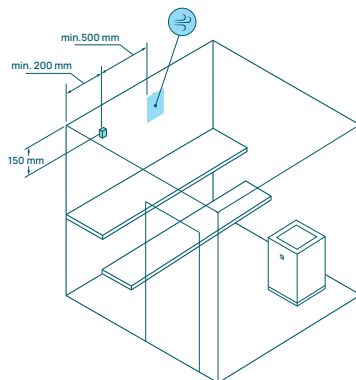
Posizione del sensore panca dall'angolo, dall'apertura e dal soffitto
